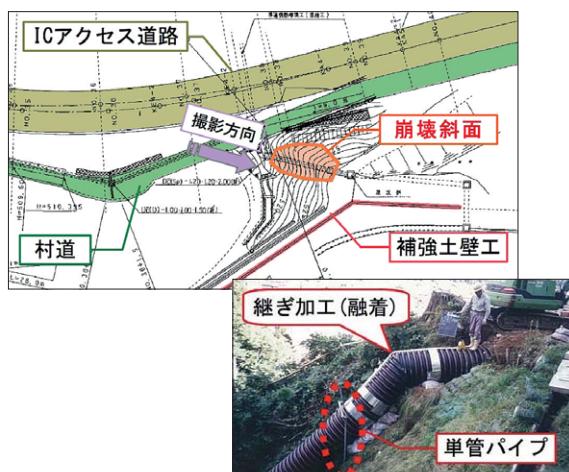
崩壊箇所の平面図とPA建設当時の施工状況
